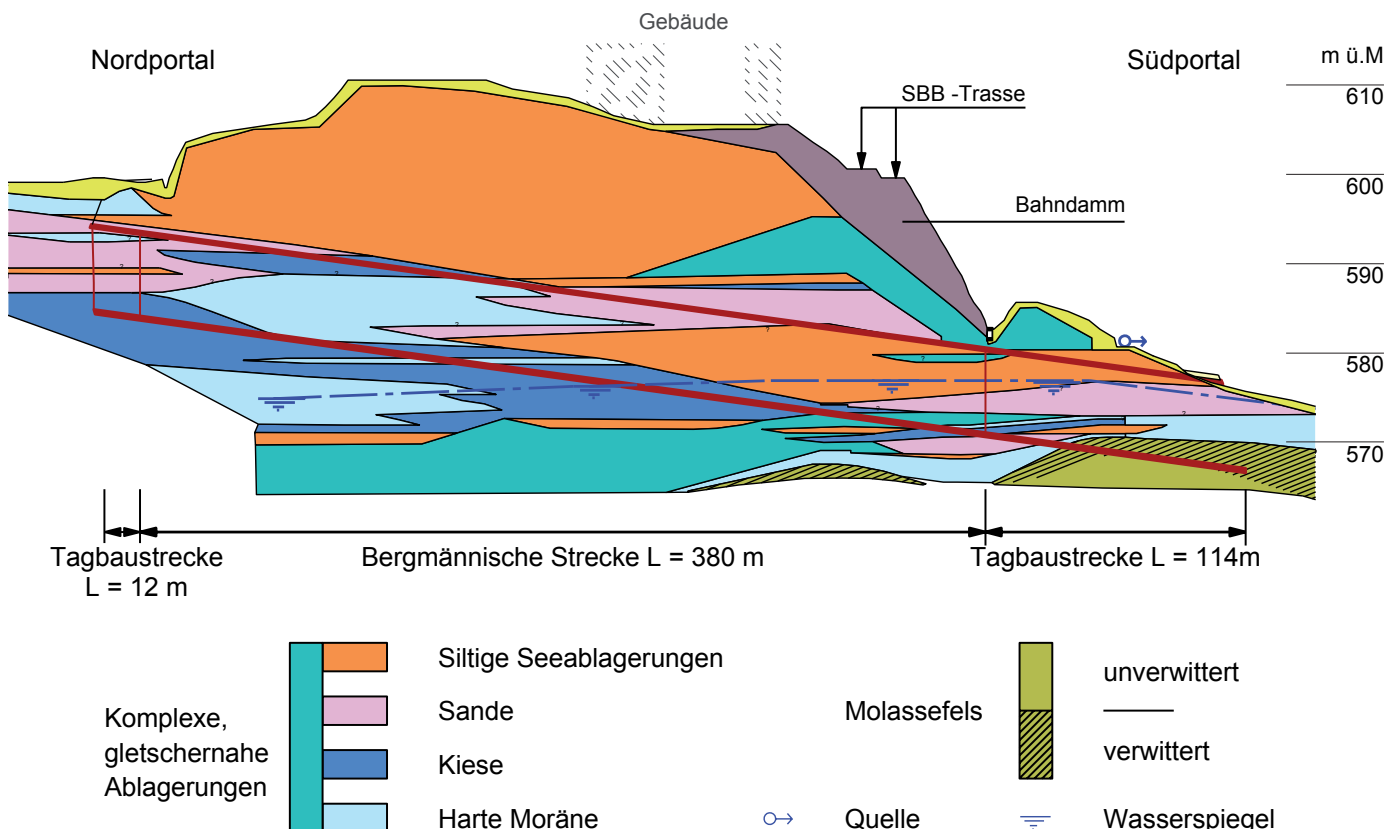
Geologisches Längenprofil Wihaldentunnel
